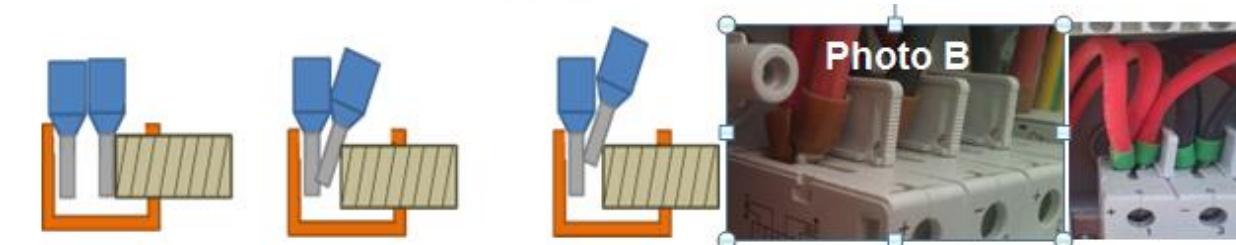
DEFAUT DE SERRAGE LIE AUX EMBOUTS DE CABLAGE
